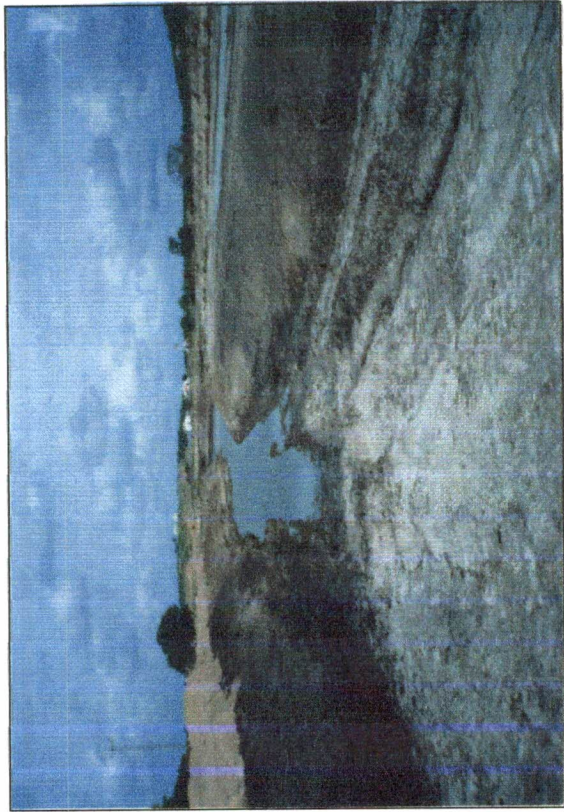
Calha central, onde foi paralisada a escavação do cut-off.
